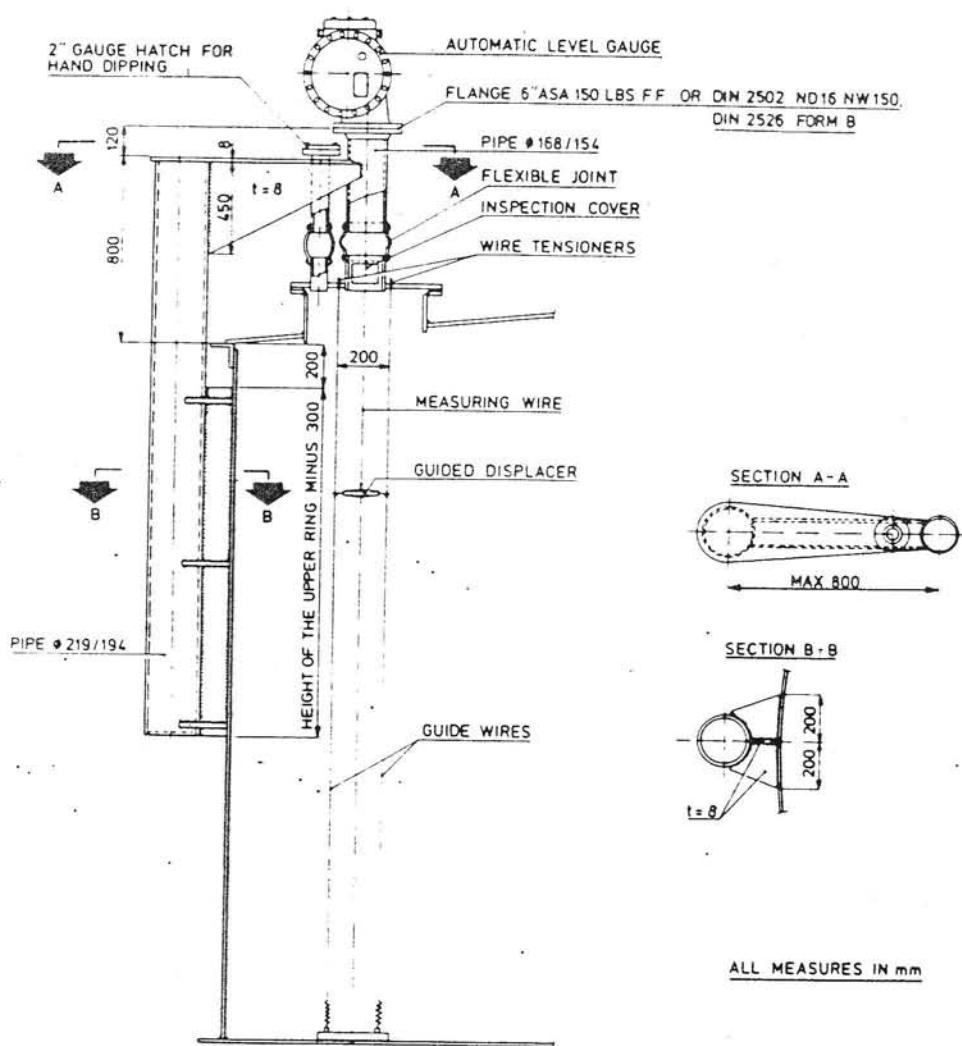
การติดตั้ง Electrically powered servo-operated gauge กับถังสำรองชนิด fixed roof ซึ่งมี roof nozzle
